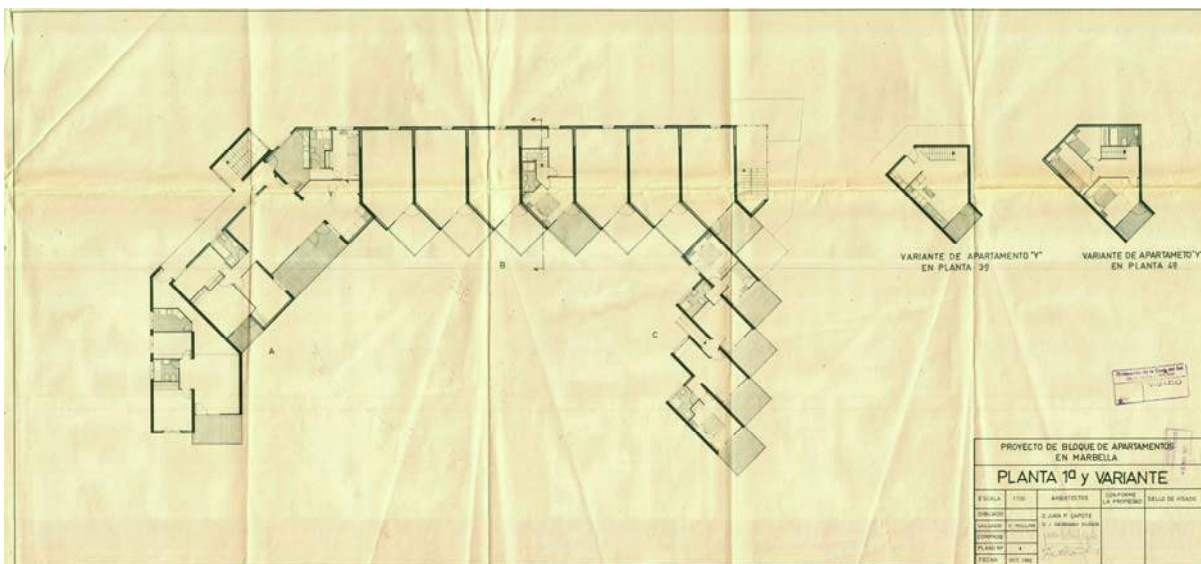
Edificio Avenida. Planta Primera y variante, (Archivo Histórico de Marbella)
